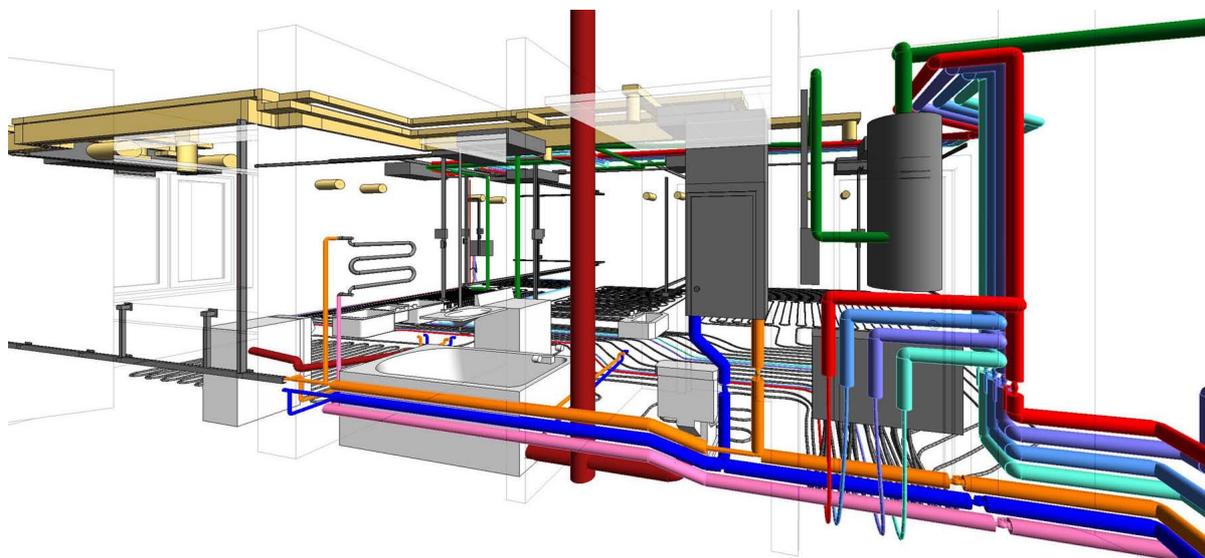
Вид квартиры со стороны трубопроводов водоснабжения.
